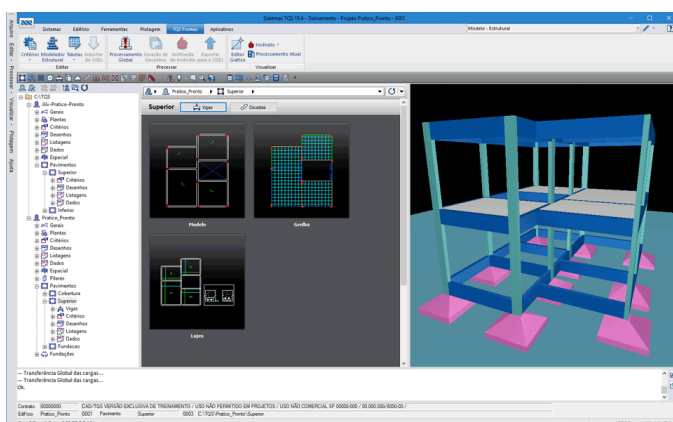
Interface do modelo 3D de uma edificação com pavimentos múltiplos e fundações em sapatas software TQS.
